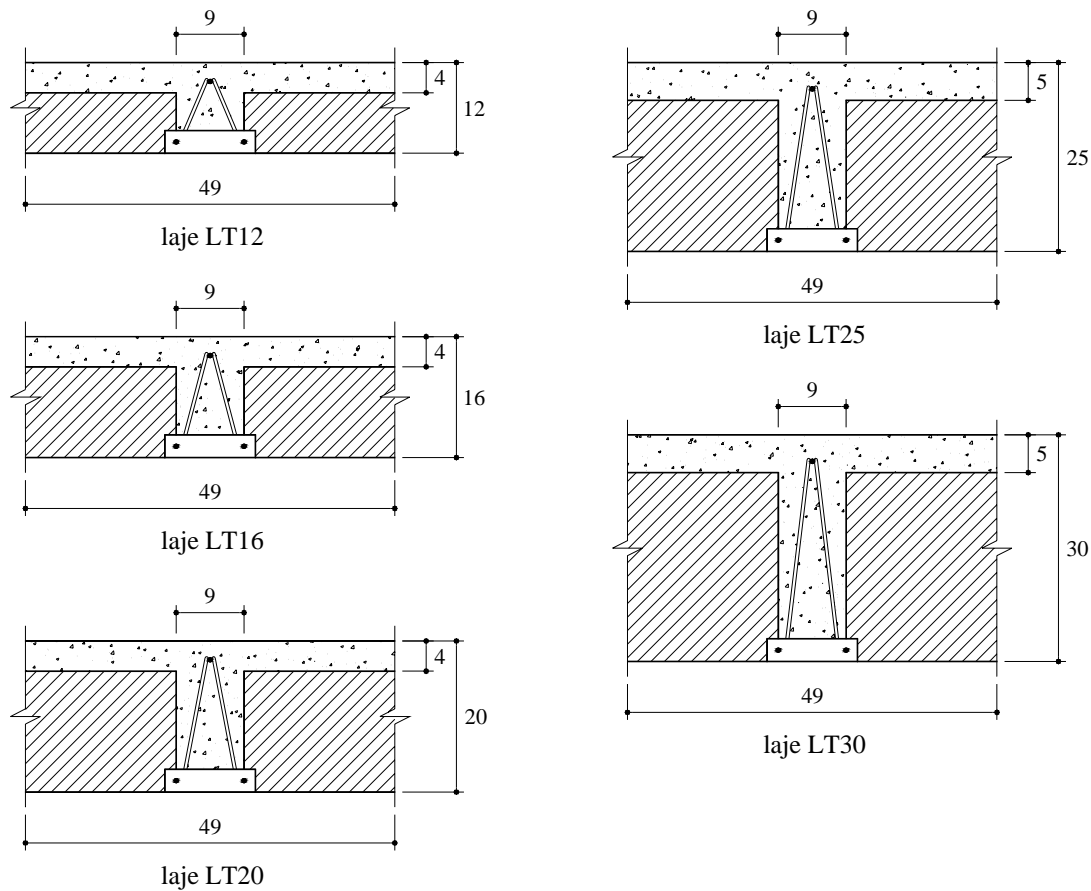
Seção transversal das lajes (dimensões em cm)
